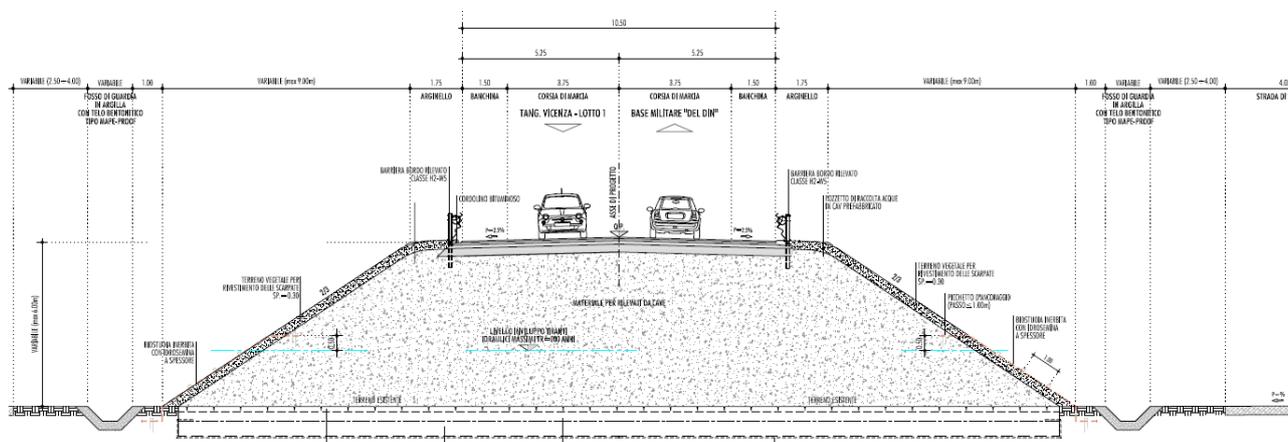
SEZIONE TIPO IN RILEVATO
